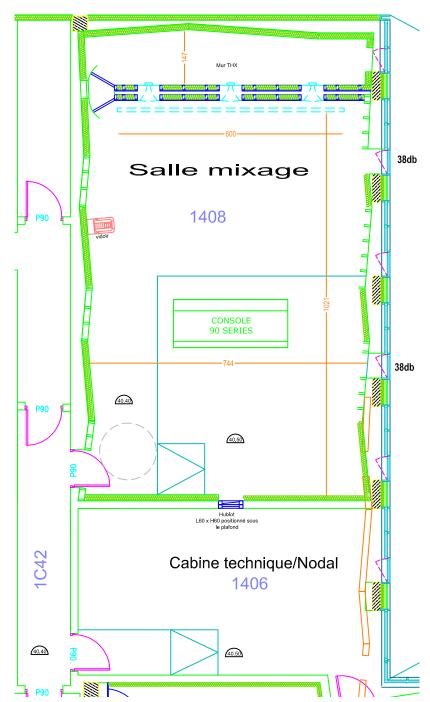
Plan de l'auditorium Hauteur sous plafond standard de 2,70m
